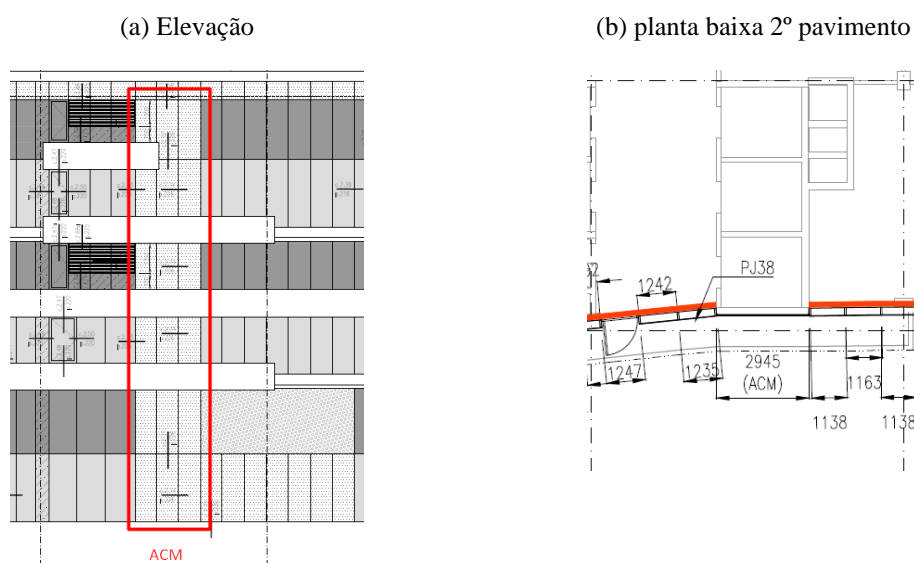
Alteração de acabamento na fachada (Trecho 05)
